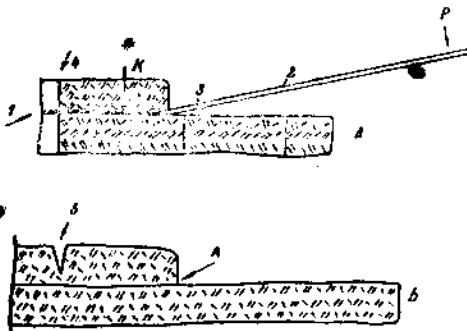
Ручная ломка камня: А—ломка по подмазке; Б—ломка с устройством бороздки. 1—подмазка; 2—лом; 3—подкладка; 4—трещина; 5—бороздка
